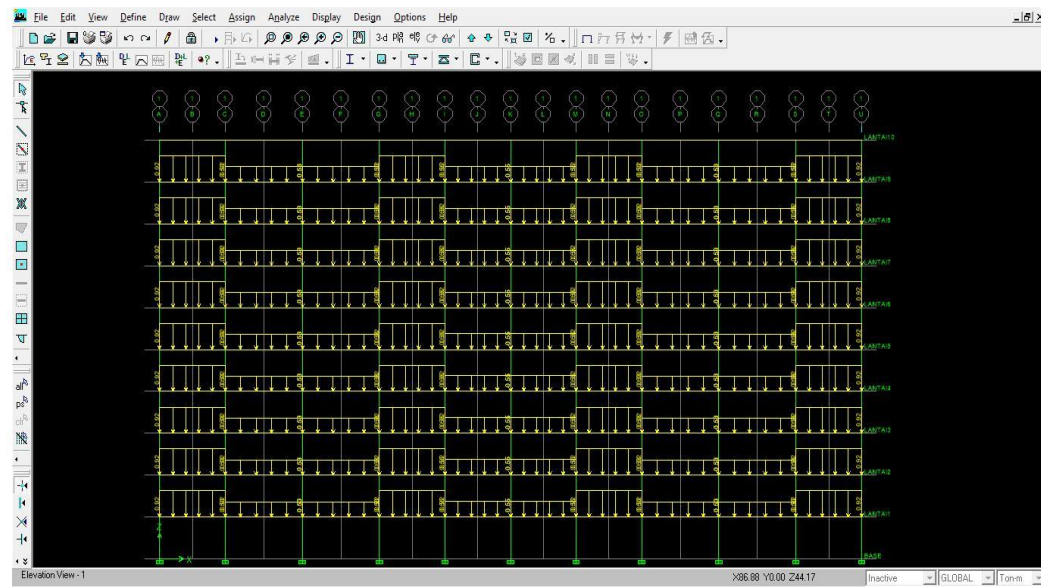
Denah Tampak Samping Arah x Struktur *Shearwall* Model 3
